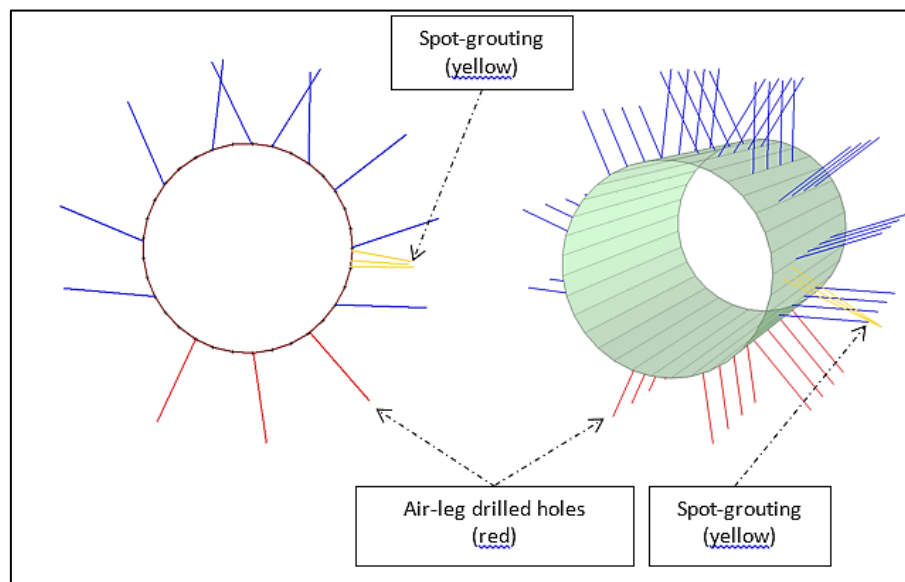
Ejemplo de patrón de diseño de grouting de post-excavación y spot-grouting complementario para TBM
